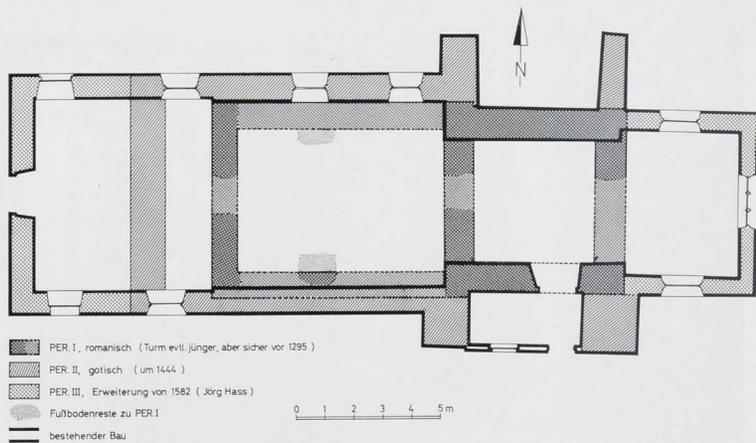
Hochdorf (Lkr. Vaihingen). Evangelische Pfarrkirche; heutiger Grundriß mit Vorgängerbauten.
